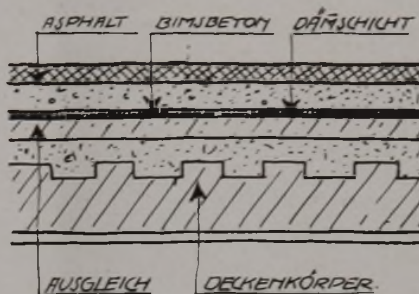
Hohlkörpermassivdecke, die infolge ihres hohen Eigengewichtes größere Schallschutzforderungen erfüllt. Die als Sicherung gegen Wasserdurchgang eingezogene Dämmschicht ist wärme- und schalltechnisch wirksam, wenn sie auf Papplage als schwimmende Schicht trogartig an den Wänden bis unter den Asphalt hochgezogen wird. Der Asphaltbelag kann auch in zwei Lagen, die untere elastisch, die obere mit größerem Gesteinszuschlag, widerstandsfähig ausgeführt werden.
